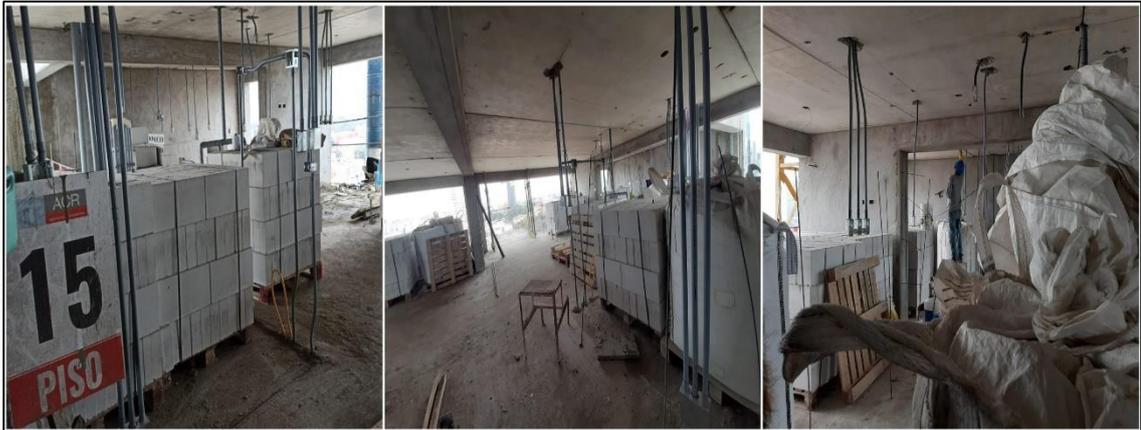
Piso N° 15 levantamiento de muros de albañilería.
